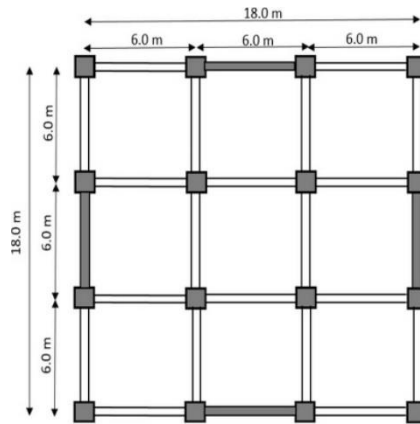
Plan de etaj curent pentru structurile cu pereți de beton armat cu P+9E și P+12E
